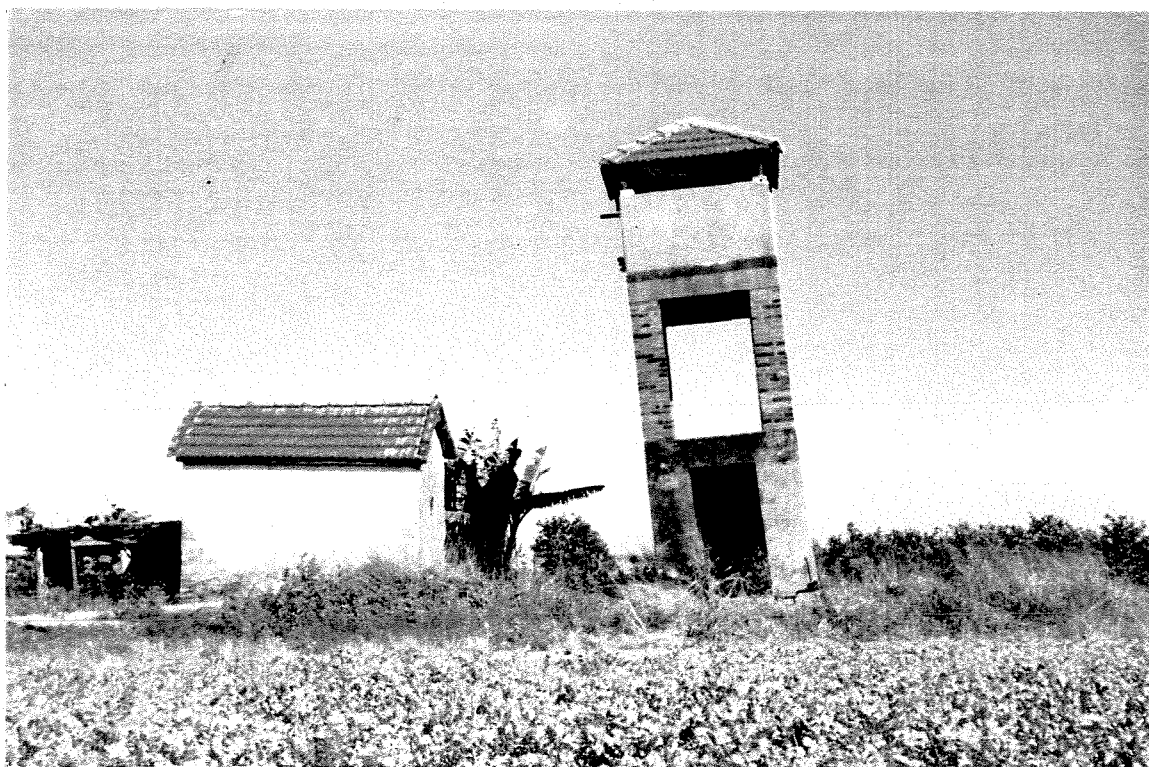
Construção apresentando tombamento por problemas de recalque de fundação.
